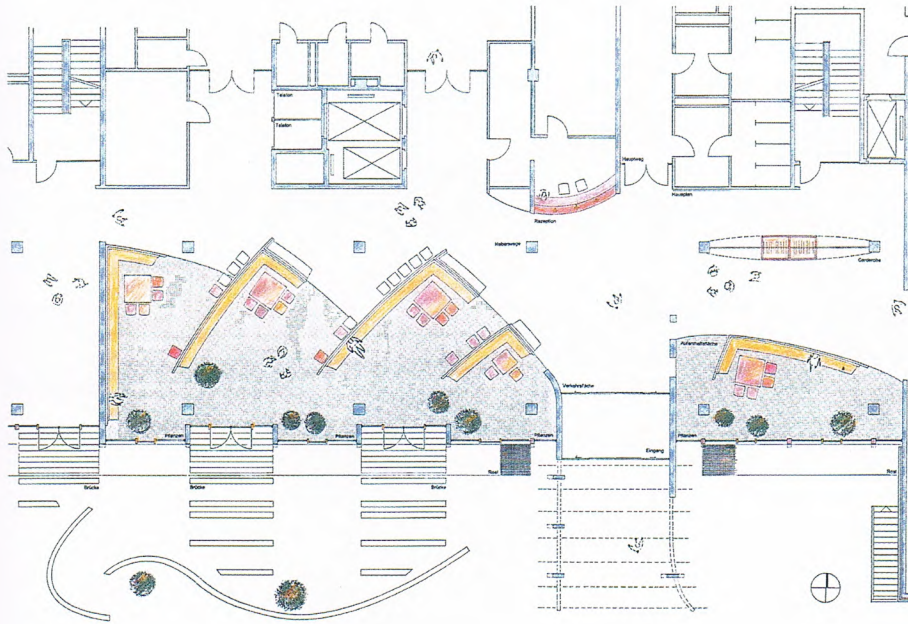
und 2 (links) Empfangshalle, Grundriß (o. Maßstab).
